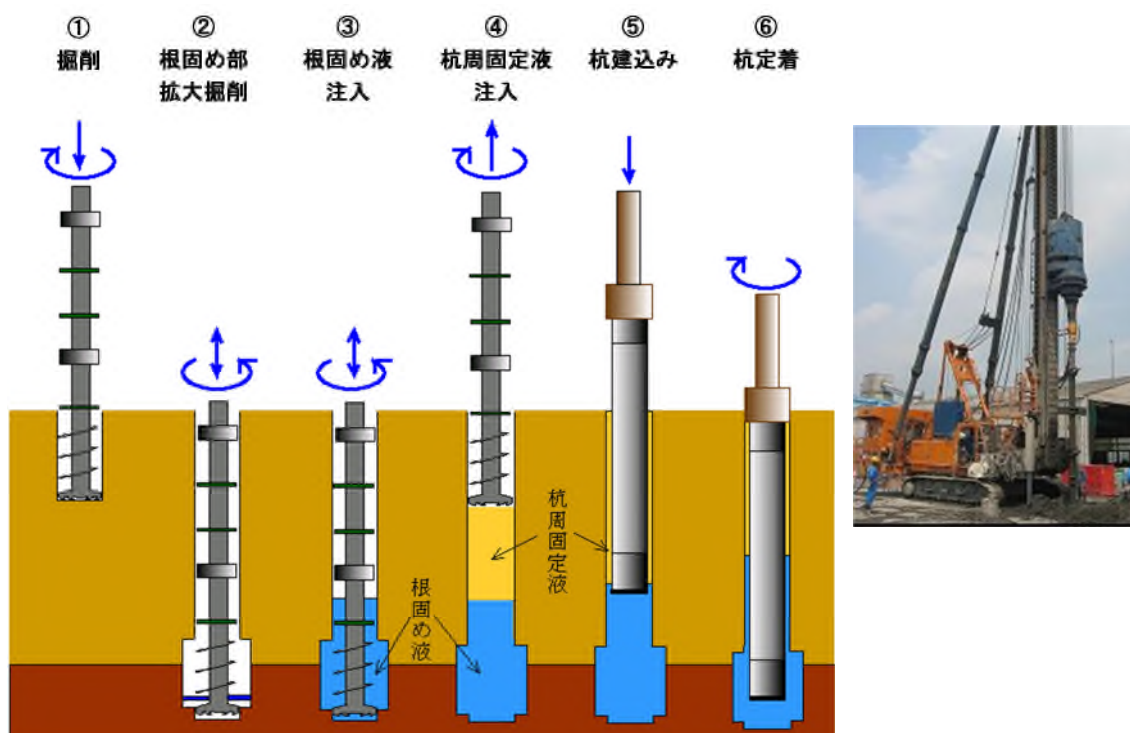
プレボーリング拡大根固め工法の施工手順と施工機械
